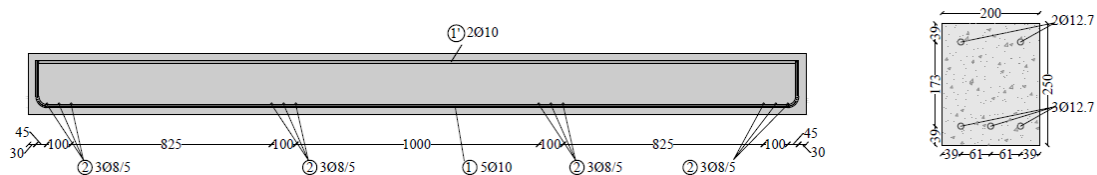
Disposición armadura longitudinal de GRFP termoplástica. Grupo 2. Ensayo armadura pasiva
